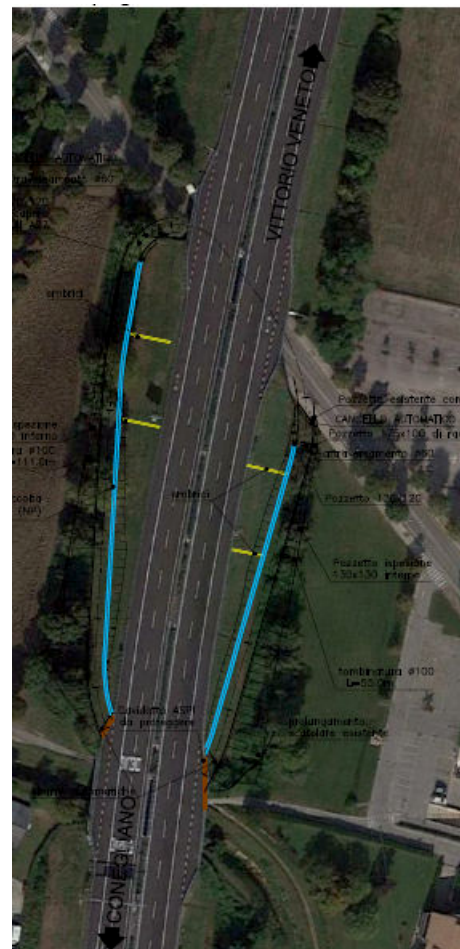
Raffronto stato di fatto e stato di progetto (Fonte: planimetria su foto aerea All. 3 alla lista di controllo)
